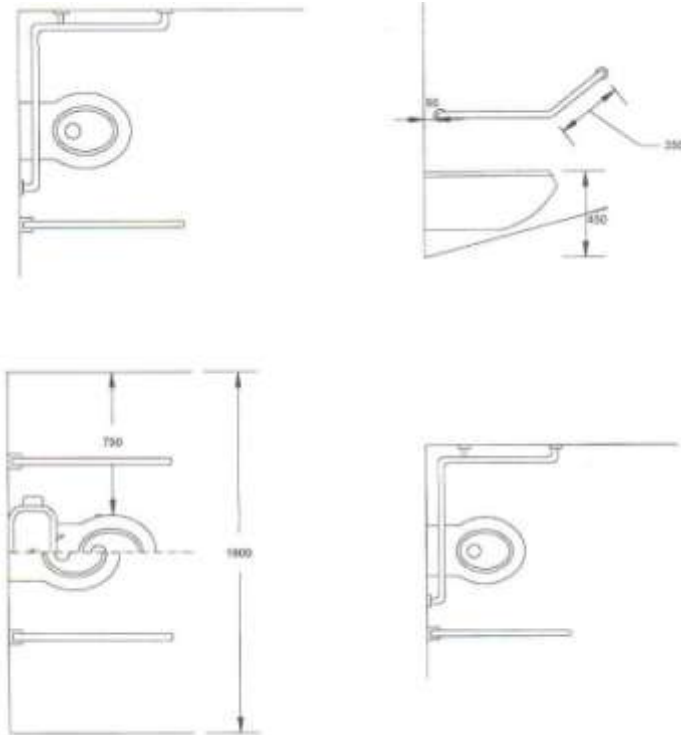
Barras de apoyo. Tipos. (Dimensiones en mm)
